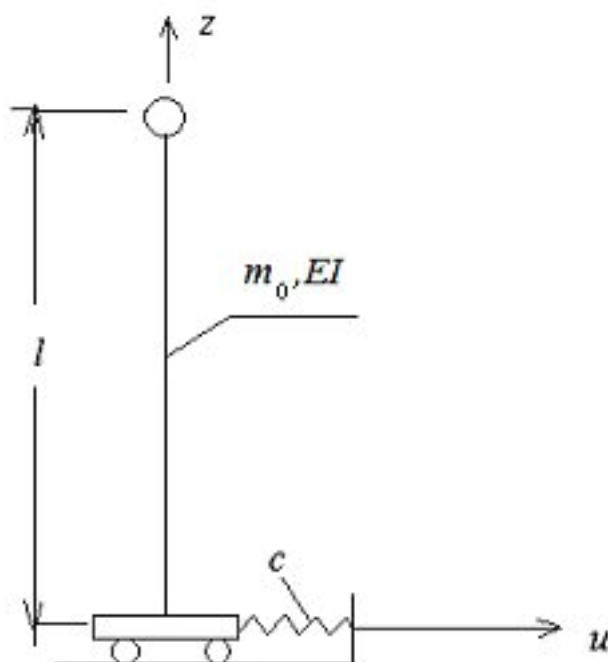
Расчетная схема линейной динамической модели КНС с сейсмоизолирующим скользящим поясом состоящим из устроенной на дне прослойки (прокладки) из «плавающего» полипропилена толщиной 15 мм (пенотерма) между сейсмоизолирующими пеностеклянными плитами толщиной 10 см. Подвижность при землетрясении самой КНС обеспечивается за счет опоясавших по периметру утилизированных автопрокрышек по всей высоте КНС заполненных на 80 процентов керамзитом и соединенных болтовыми соединениями по изобретению № 2044845, 2282693 или изоляция с грунтов выполнены из уложенным в два ряда пеностеклянных плит толщиной 20 см с устройством «плавающее» прослойки из вспененного полипропилена (пенотерма) толщиной 1 см на всю высоту 6 метров КНС с устройством пластового дренажа вокруг КНС.
